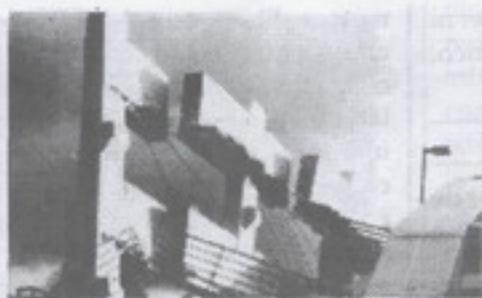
Columnas de formas T-múltiple que forman los pórticos exteriores norte-sur del edificio de estacionamiento CalState. Se observan las ménsulas que proveían apoyo simple a las vigas prefabricadas. La conexión no provee continuidad y no tiene capacidad para asegurar la integridad estructural. No existe conexión efectiva entre columnas-portal adyacentes.
